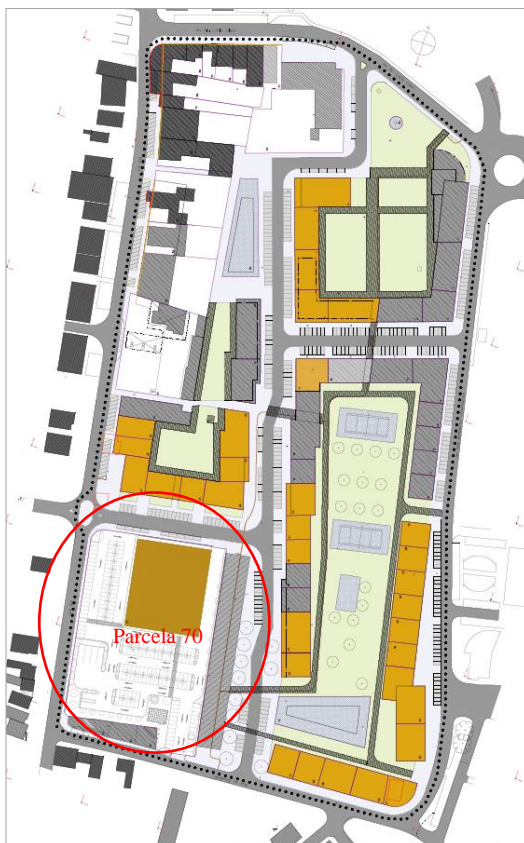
Proposta de ocupação urbana - extrato da Planta de Implantação do PP em vigor
